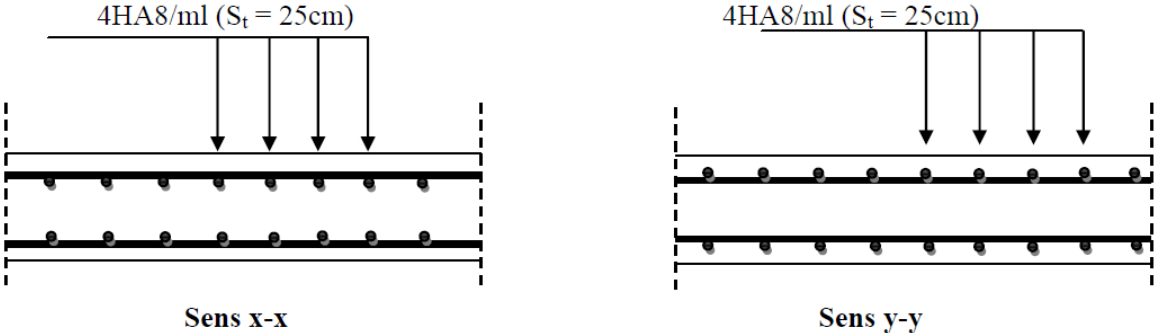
Ferrailage de la dalle pleine de la salle machine
